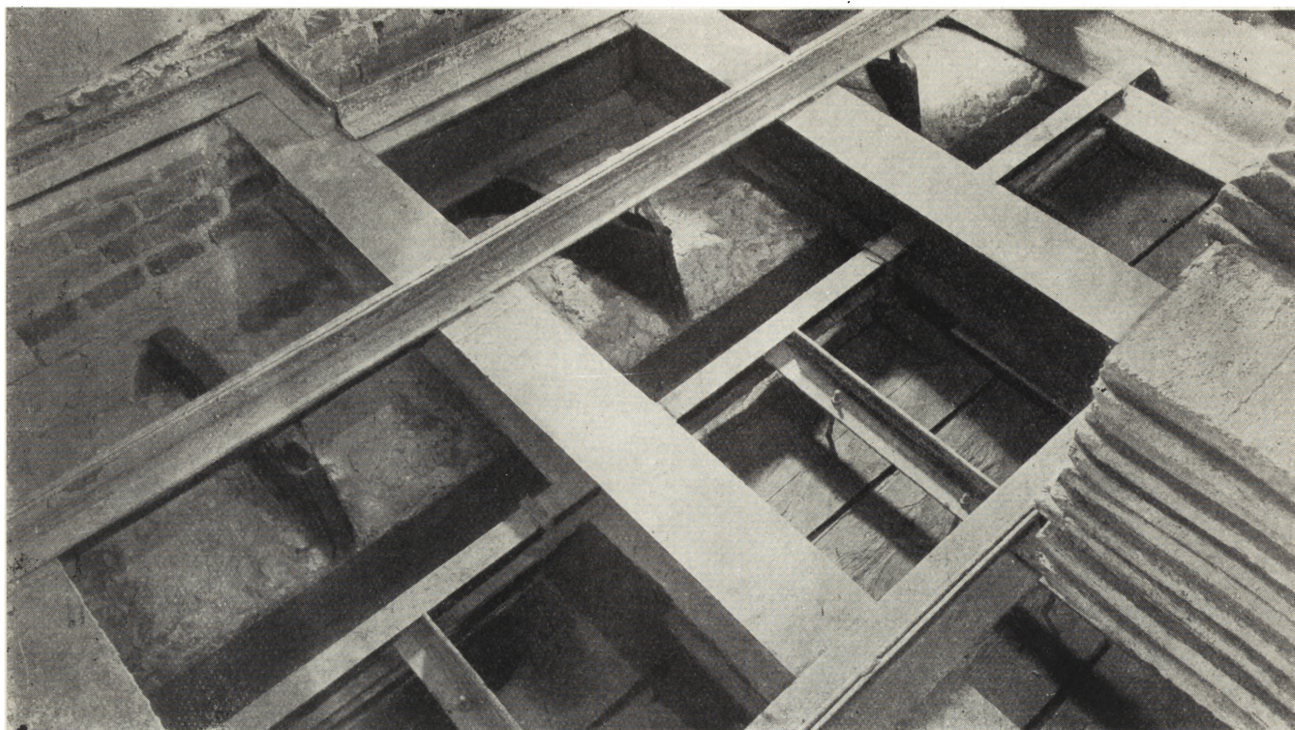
Galeria południowa, pierwsze piętro, widok ogólny
